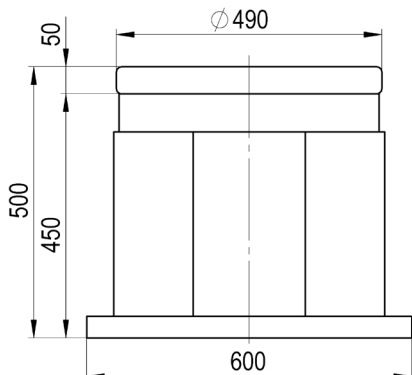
Колодец ККП-1-ССД, вид сбоку, габаритные размеры
